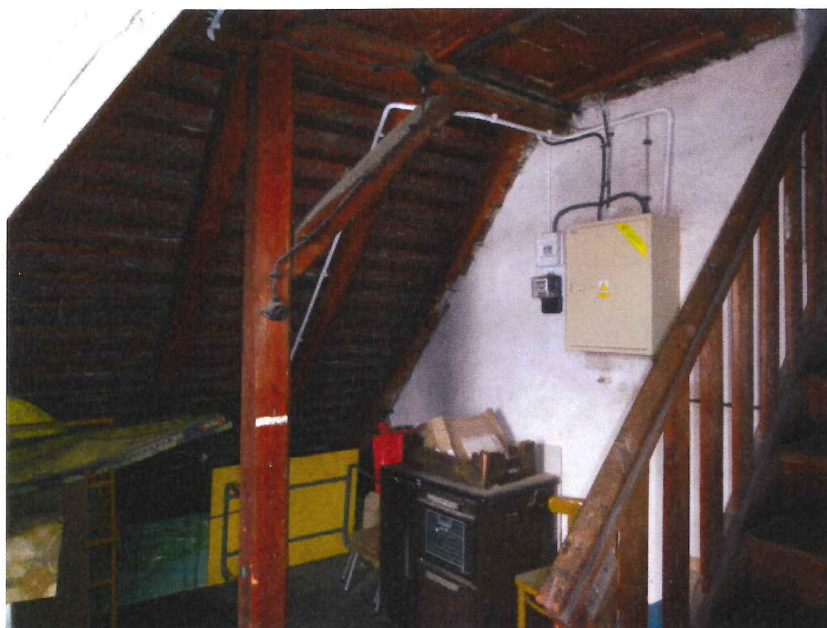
widok strychu przy klatce schodowej do proponowanej adaptacji na szatnię.
